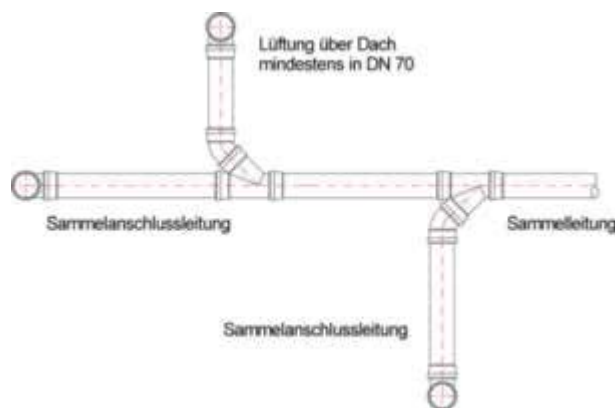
Erforderliche Lüftungsmaßnahmen bei Entwässerungsanlagen ohne Falleitungen
